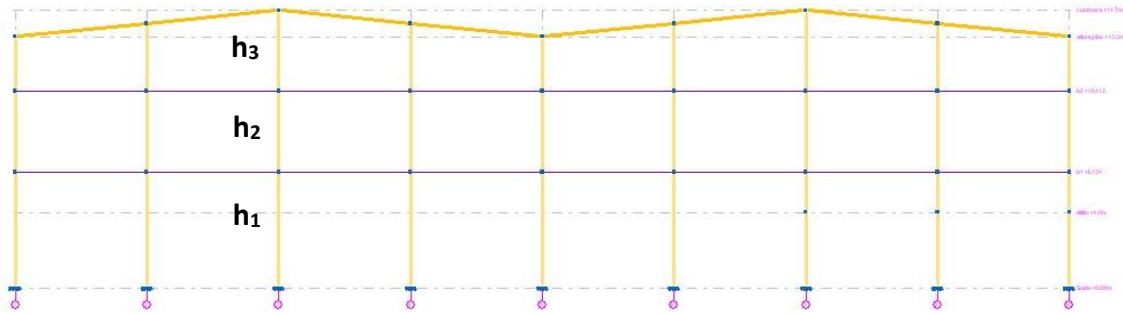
Sistema de arriostramiento del pórtico de fachada. CYPE 3D.
